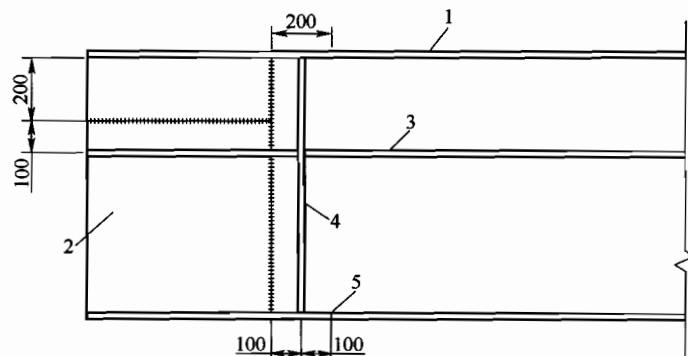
焊缝错开的最小距离 (单位:mm)
